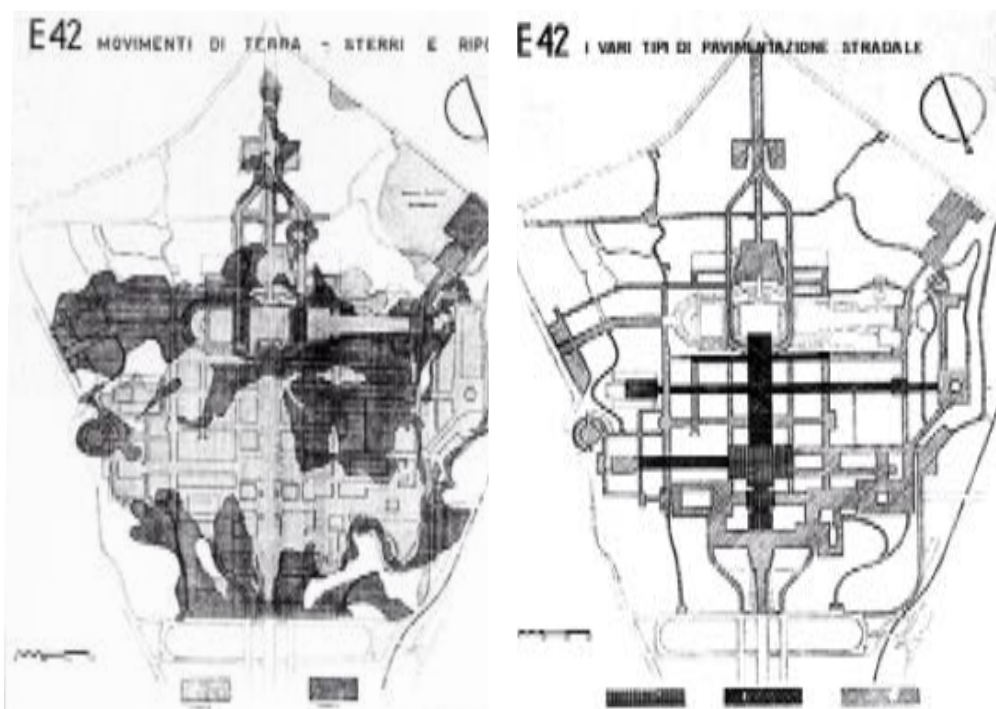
| Planimetrie dei movimenti terra (a sinistra) e delle varie tipologie di pavimentazioni previste per strade e piazze (a destra).
